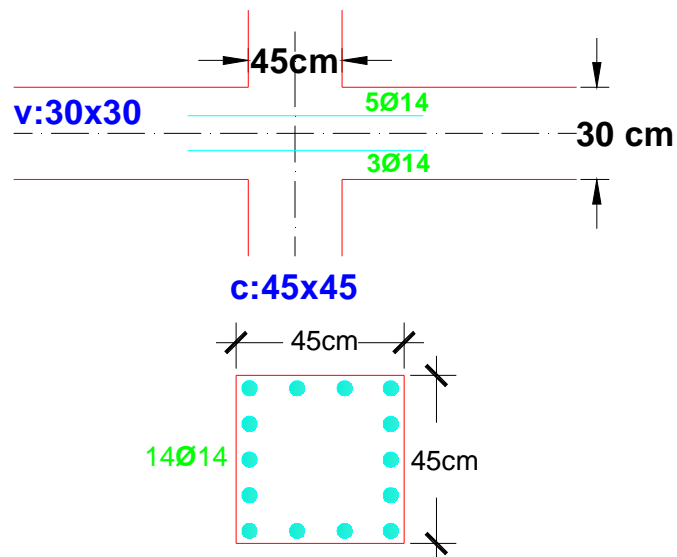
Dimensiones y refuerzo de viga y columna
